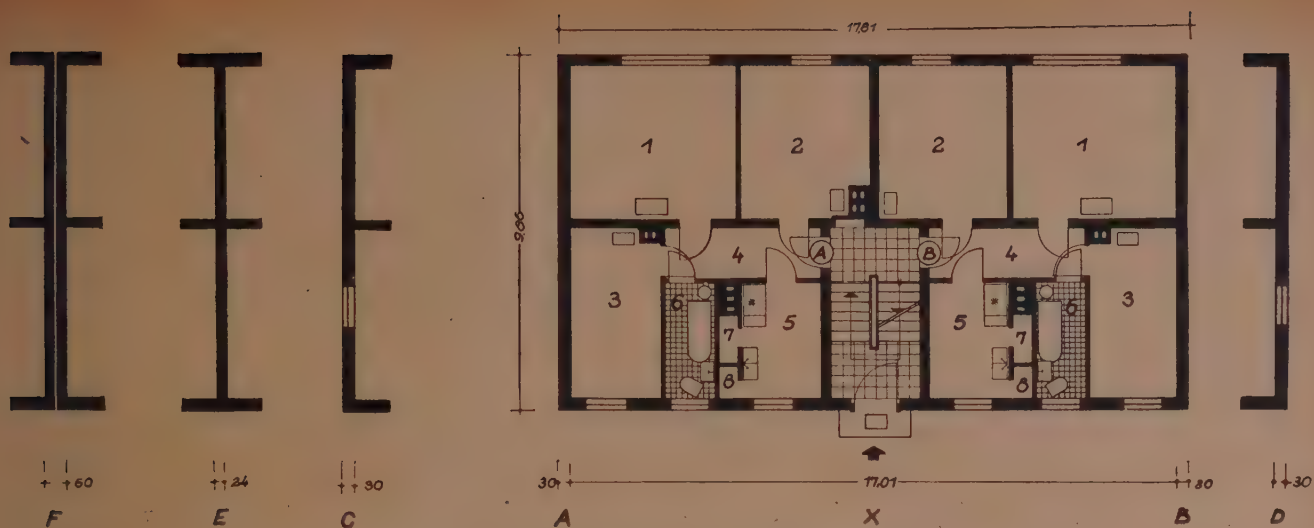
Sektion W 56/2 Leipzig - Wohngeschoßgrundriß
